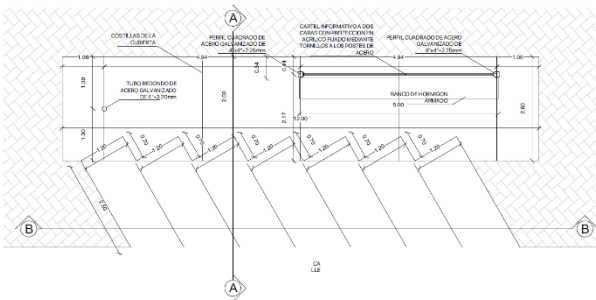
Vista en planta arquitectónica y sección de parada de motos. Fuente: URBE, octubre 2025
